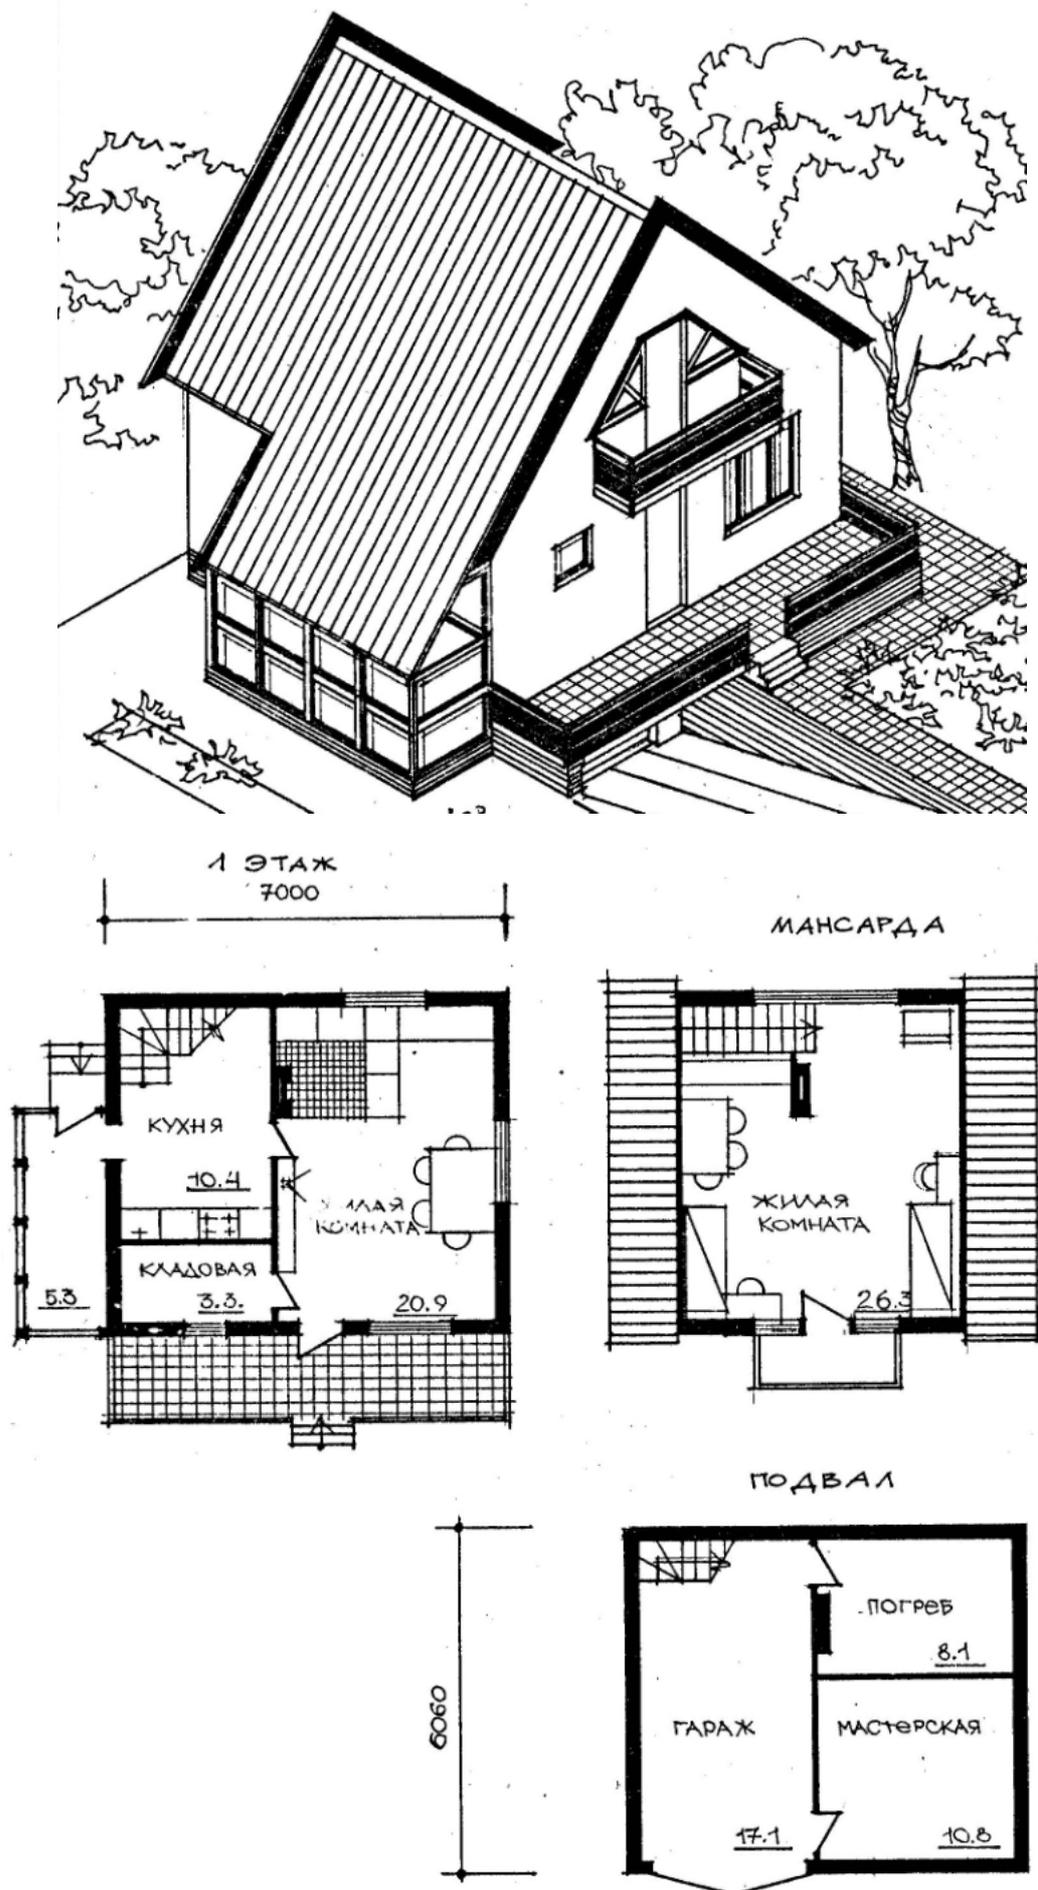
Жилой дом (жилая площадь 47,2 м²; общая площадь 102,2 м²)
